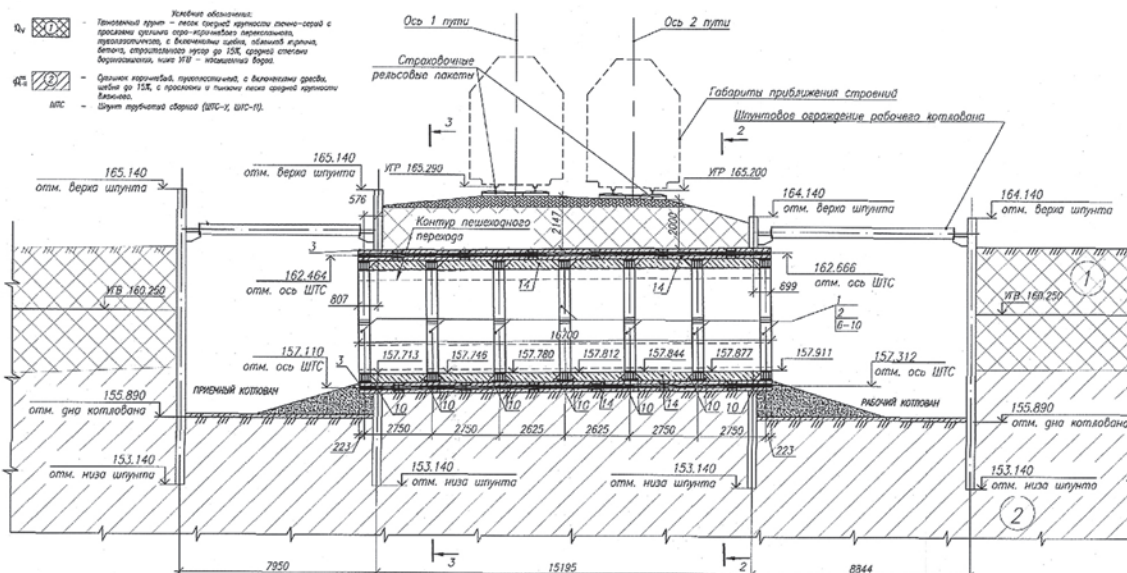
Продольный разрез защитного экрана из труб / Fig. 2. Longitudinal section of the pipe-roof structure
